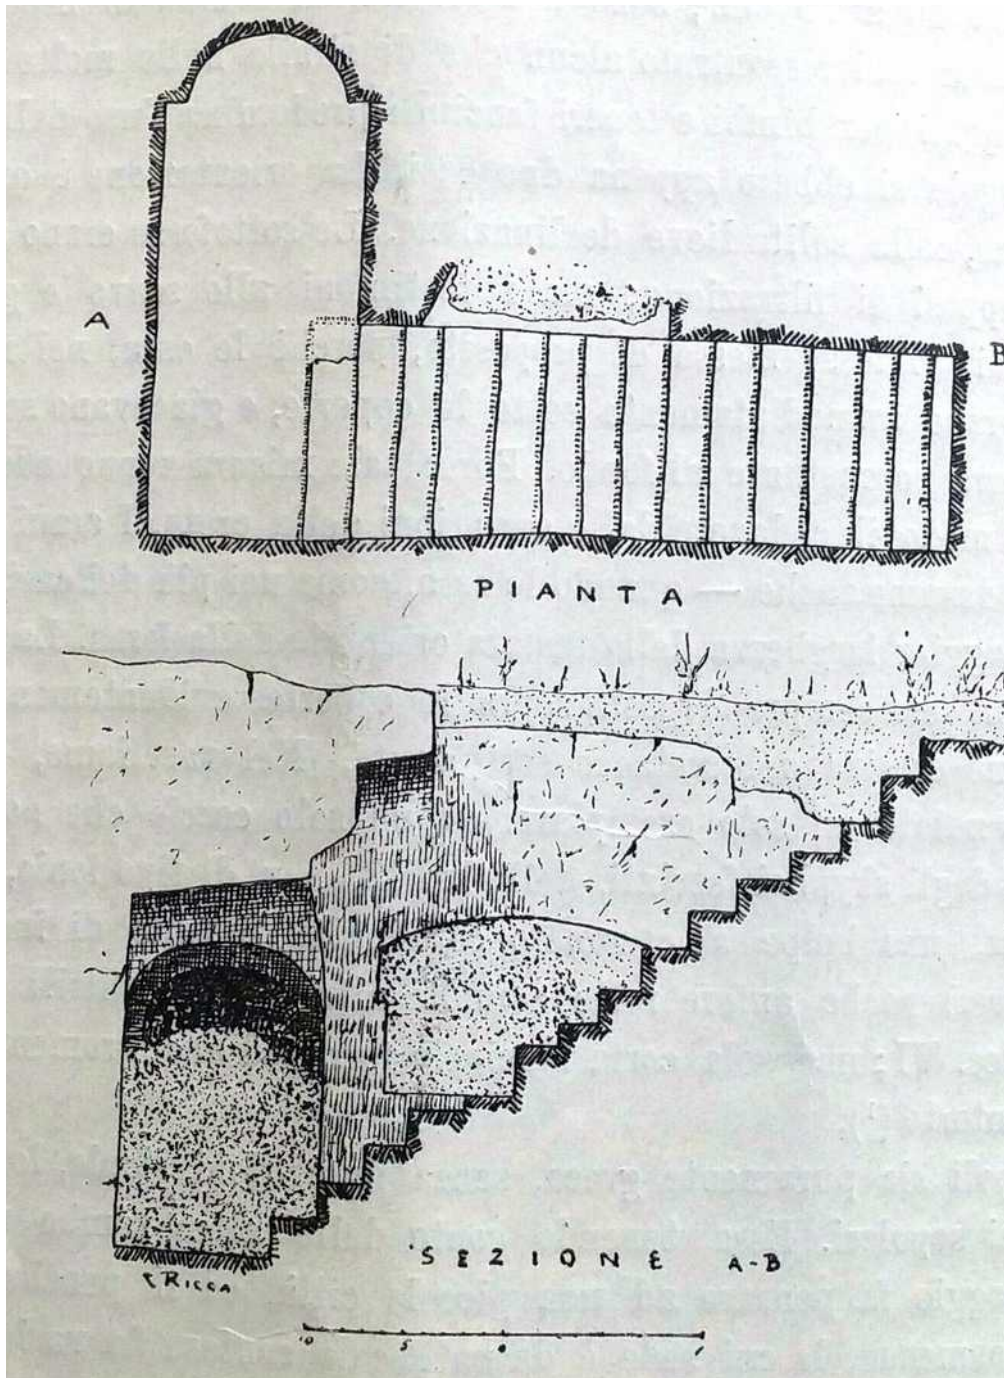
Avola- C. da Stradicò - Planimetria e Sezione Ipogeo
